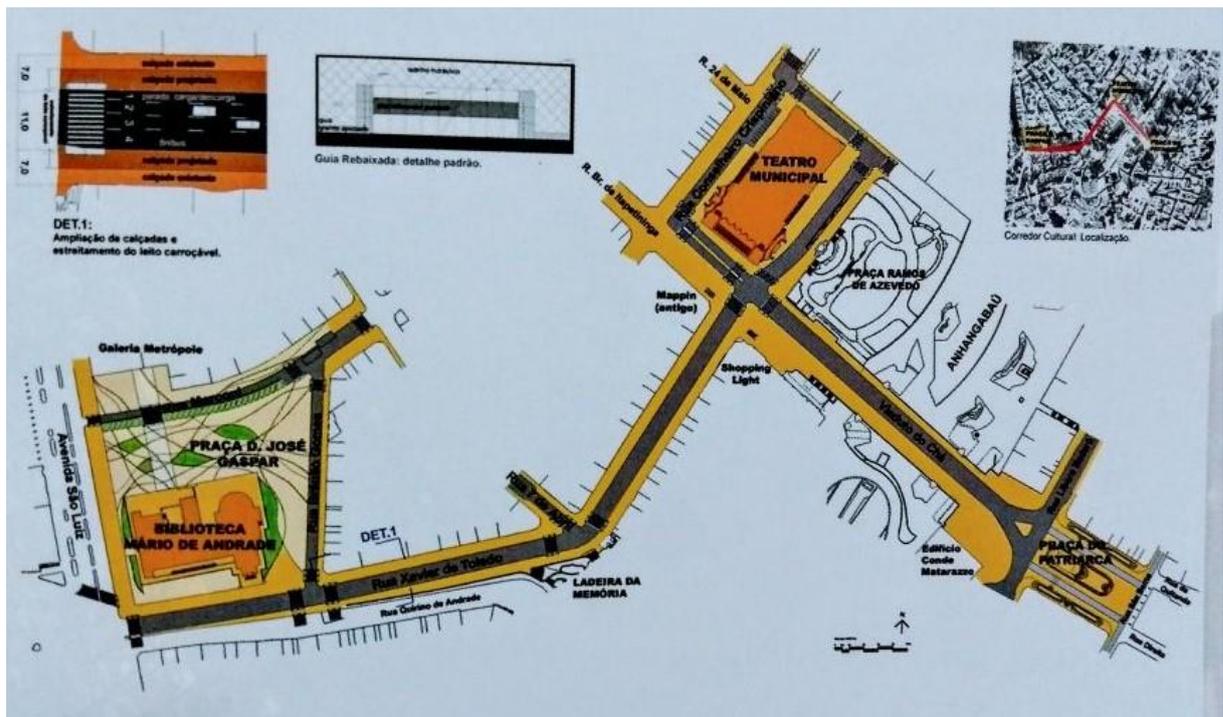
Planta esquemática da área de intervenção do Projeto Corredor Cultural de São Paulo.
